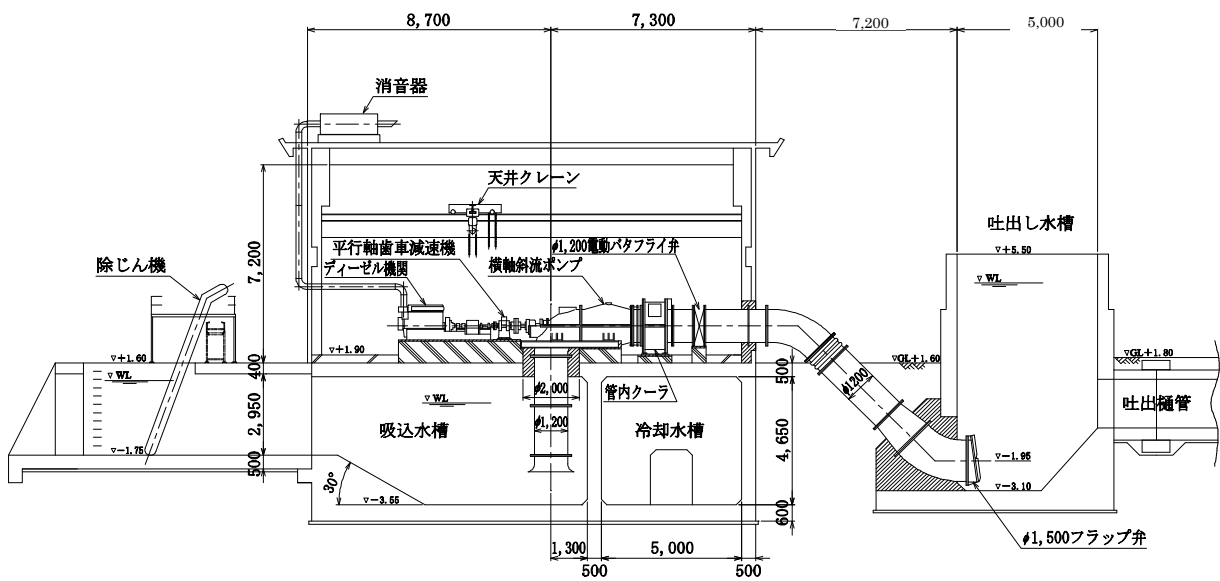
(a)-参 横軸斜流ポンプ平面図（例）
